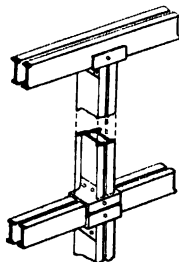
Assemblage d'un poteau en fer à T.
